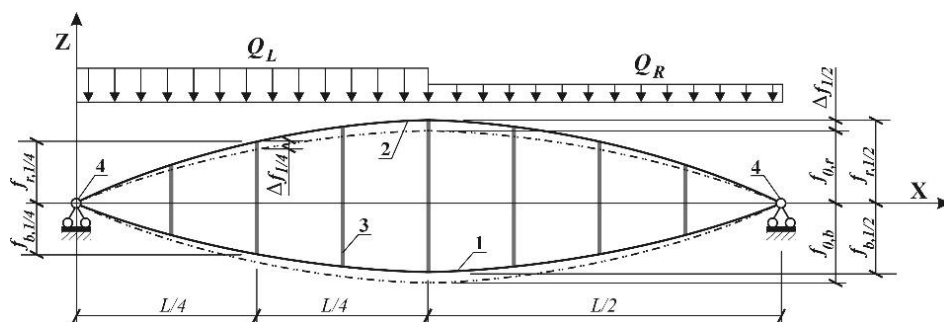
Расчетная схема двухпоясной вантовой фермы:
